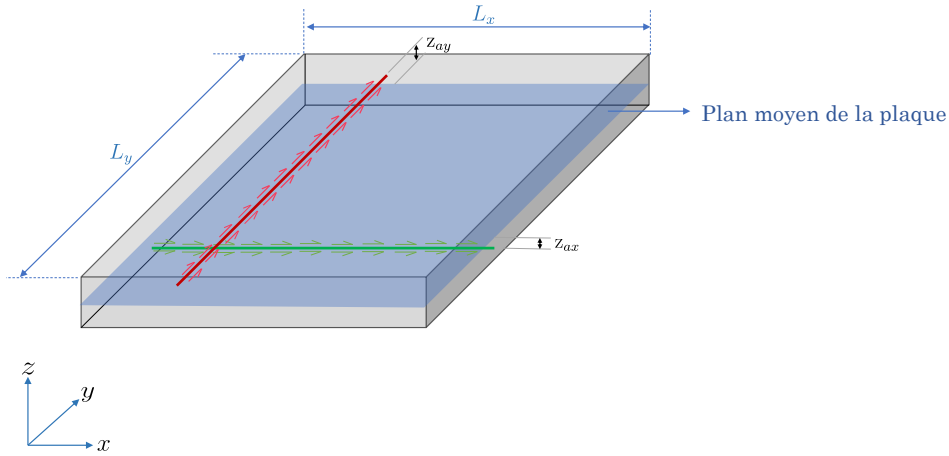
Excentrement des barres d'acier par rapport au plan moyen de la plaque de béton.
